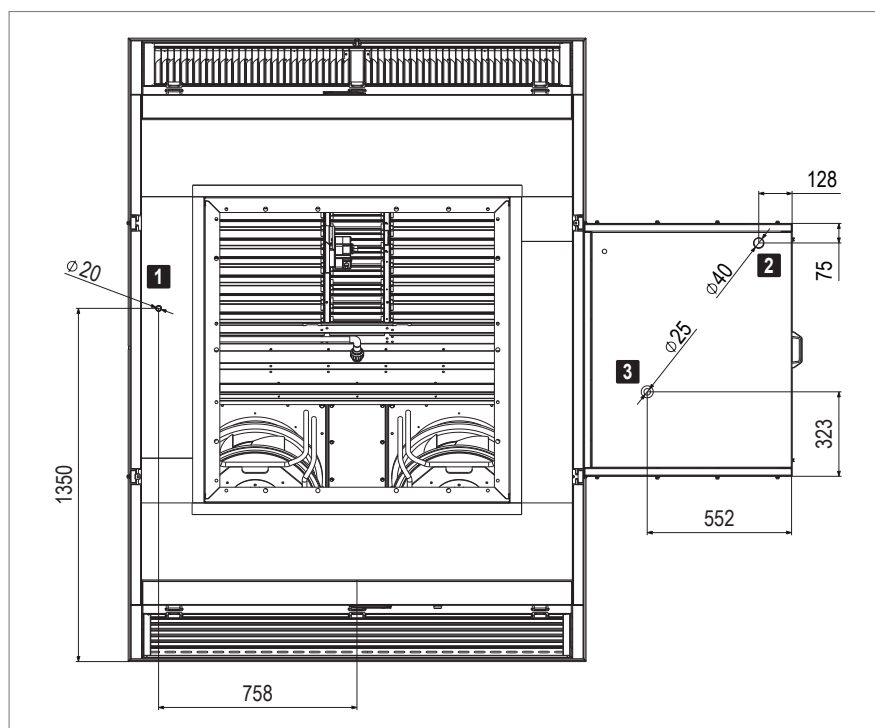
Dimensions RoofVent® RG (dimensions en mm)
